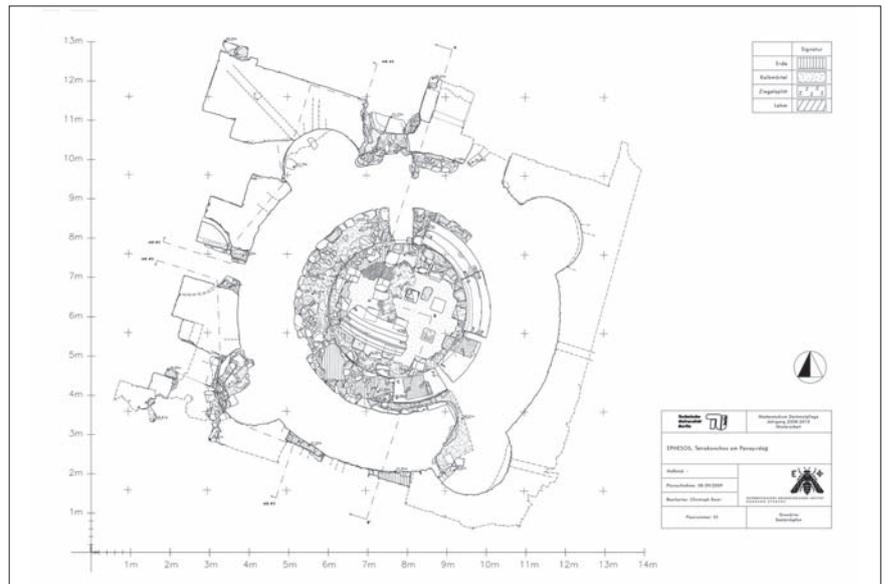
Ephesos, Tetrakonchos am Panayırdağ. Grundriss Bestand, o.M. (Aufnahmemassstab 1:20), 2009.
